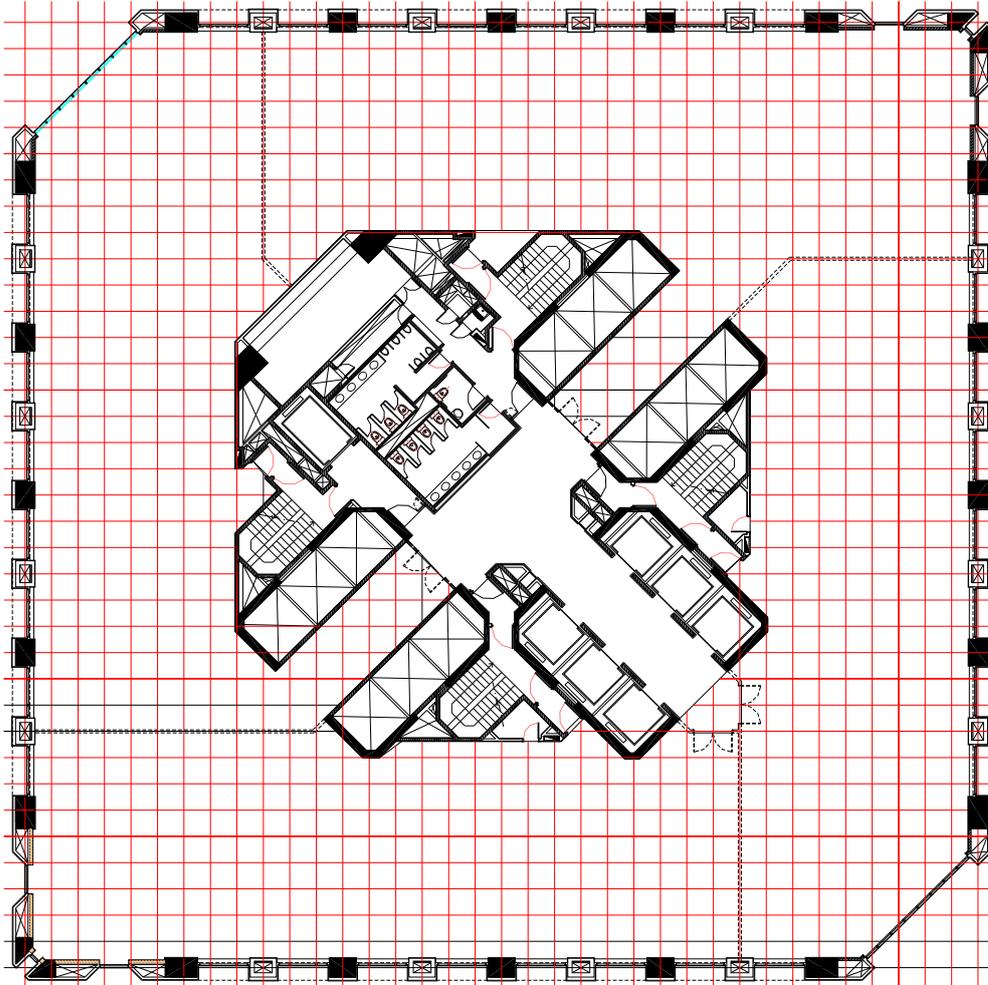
Pavimento-tipo Torre Norte. Observa-se a possibilidade de subdivisão para até quatro ocupantes
